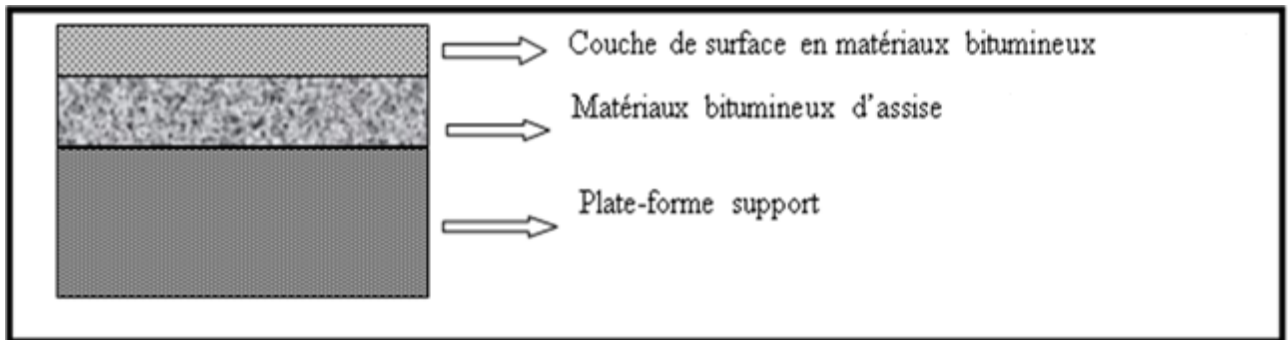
Structure type d'une chaussée semi-rigide
